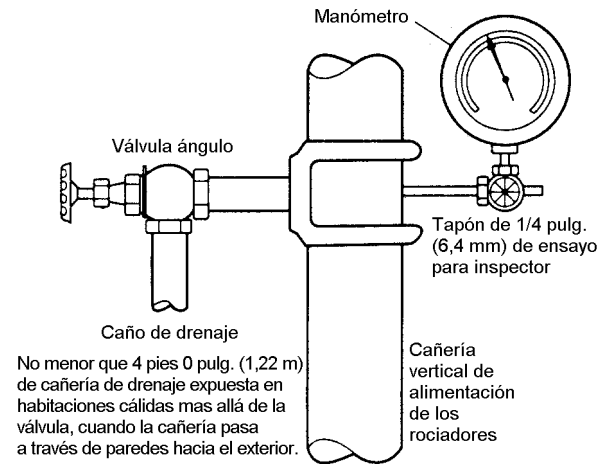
Conexiones de Drenaje para Tubería Vertical de Alimentación del Sistema.
